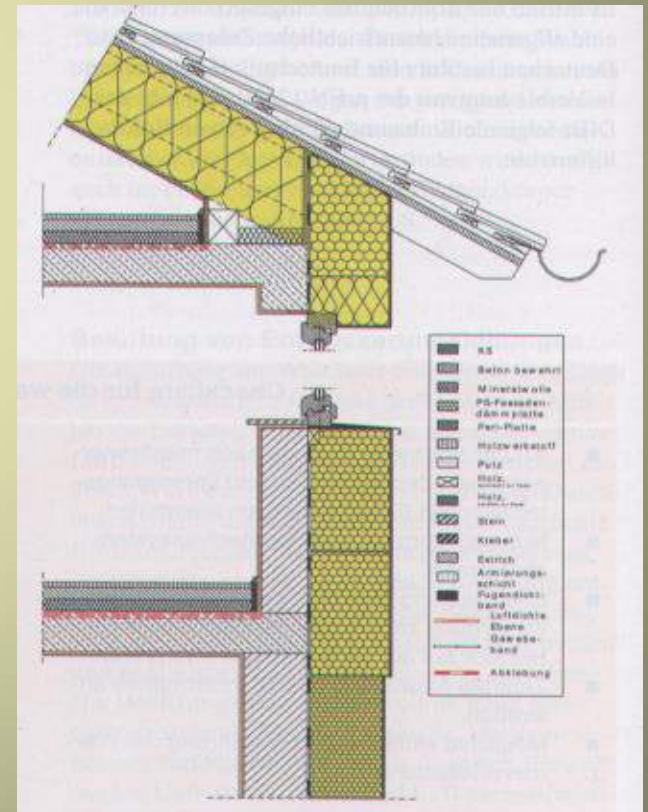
Anschlussdetail Ortgang, Massive wand an Holz-Leichtbau Dach. Die Mauerkrone ist hier nicht, wie sonst üblich in die Dämmebene des Daches hochgezogen.
